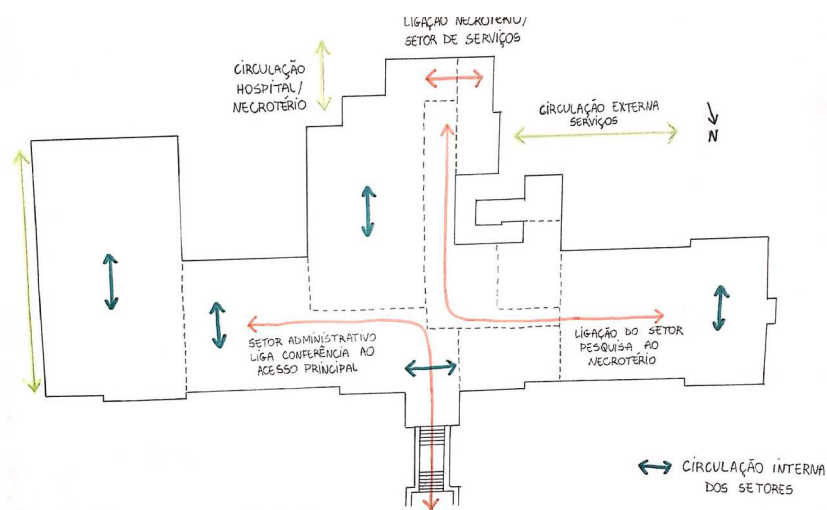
Diagrama preliminar de fluxos pavimento térreo.
